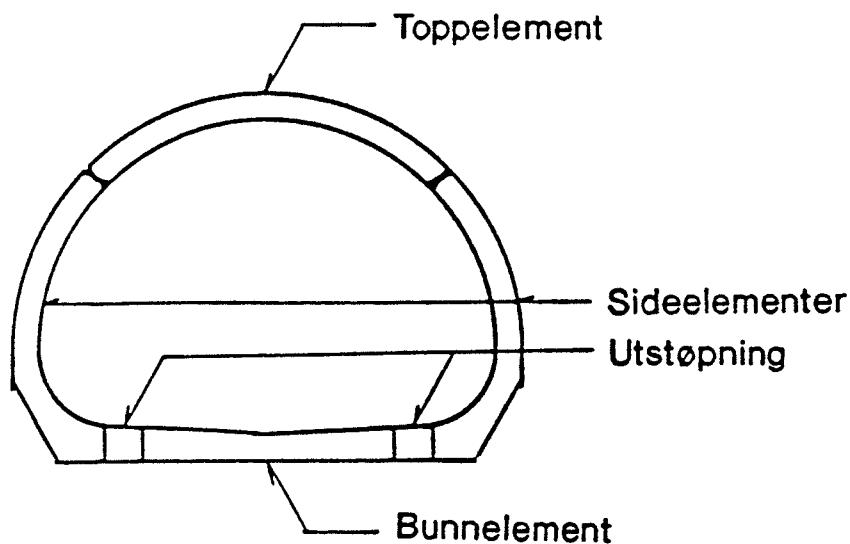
Løsmassetunnel av betongelementer, prinsipp
